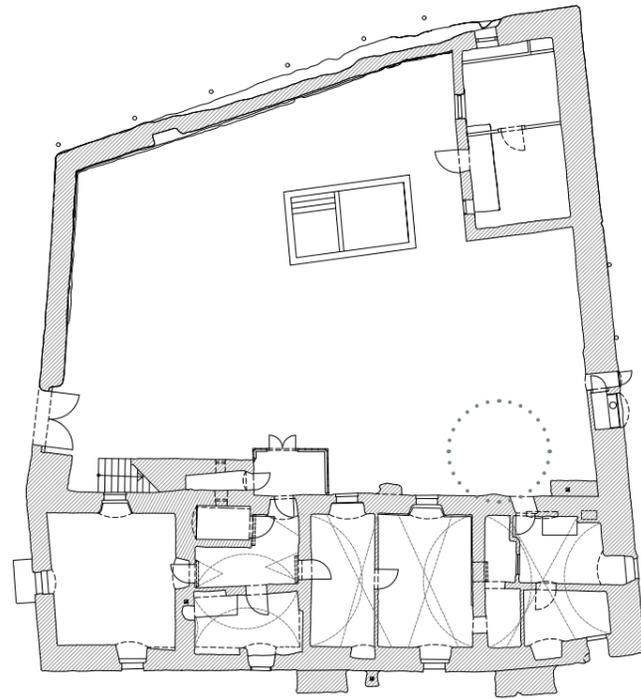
Lage ehemaliger Brunnen, Grundriss Erdgeschoß
